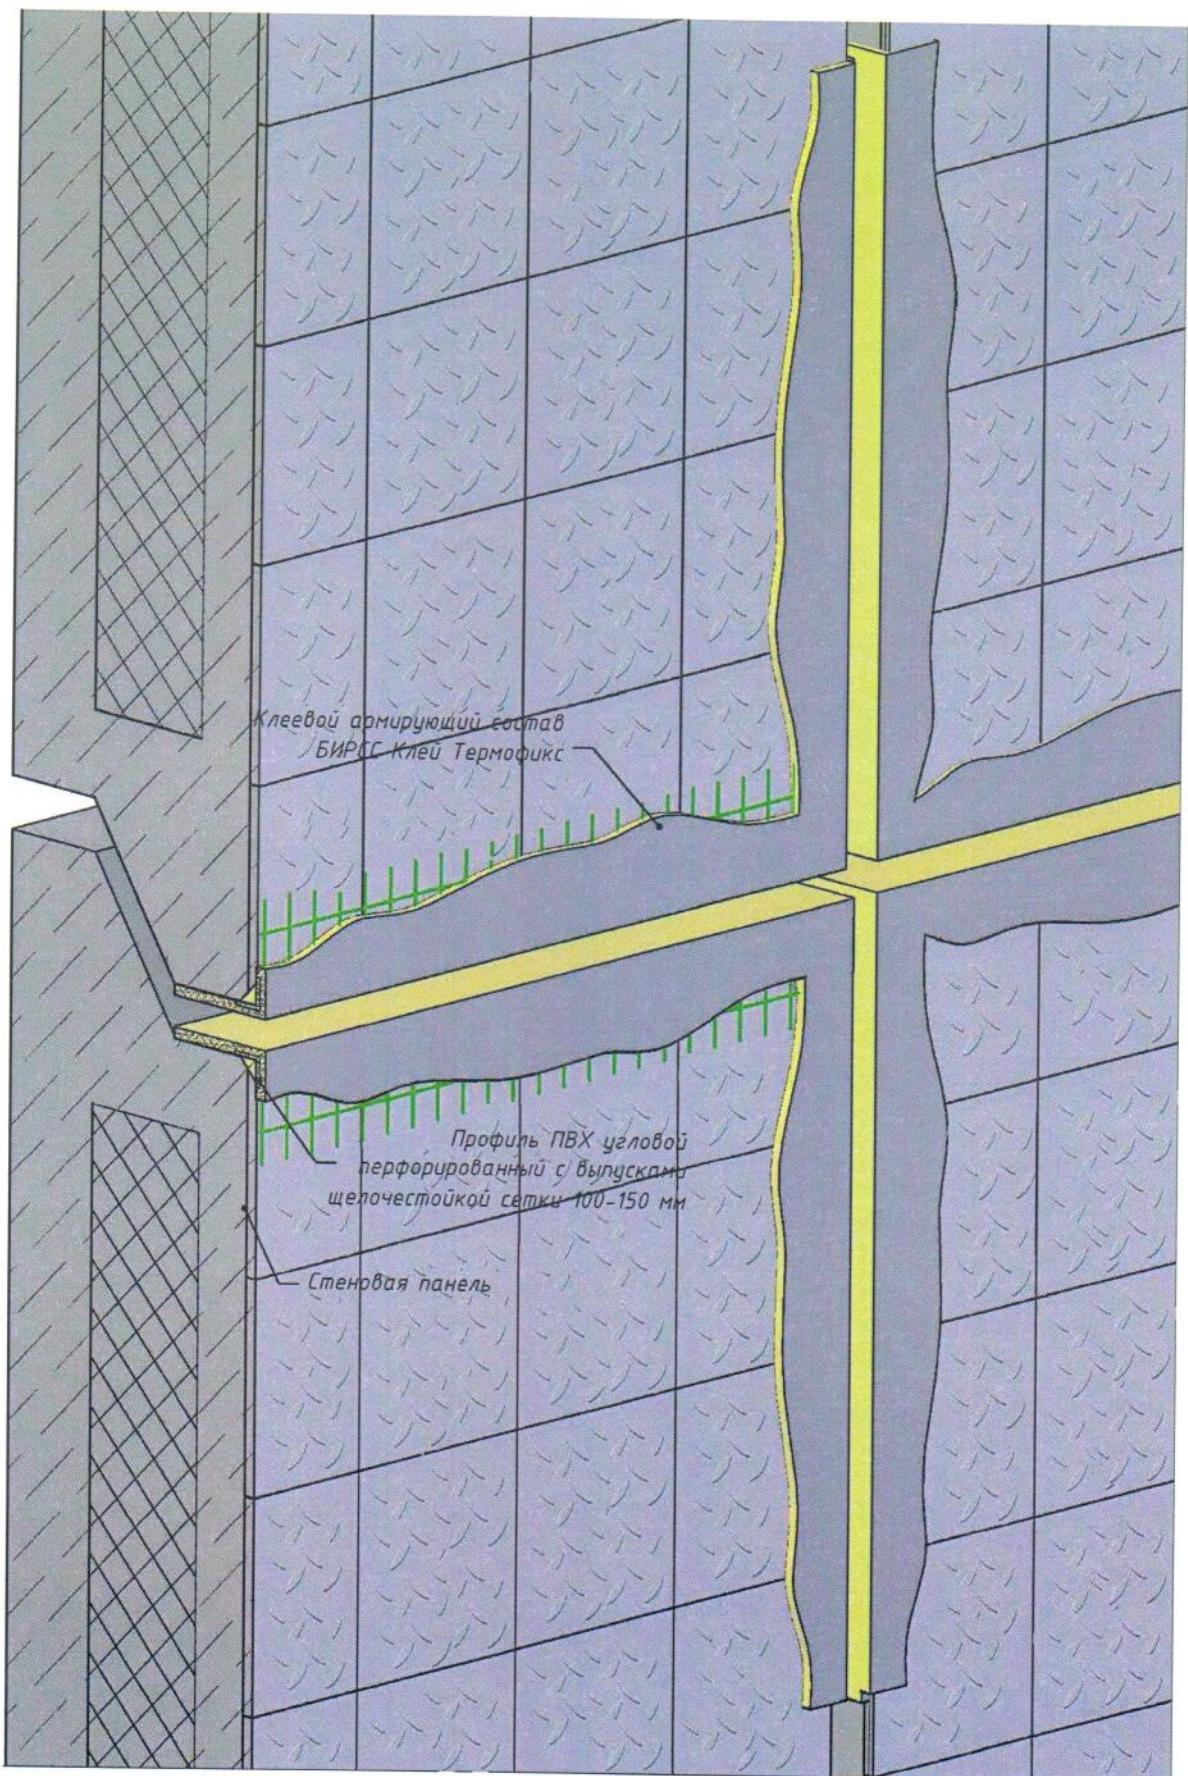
Армирование межпанельного шва угловым профилем из ПВХ с фасадной сеткой (затирка вторым слоем цементной клеевой смеси БИРСС Клей Термофикс)
